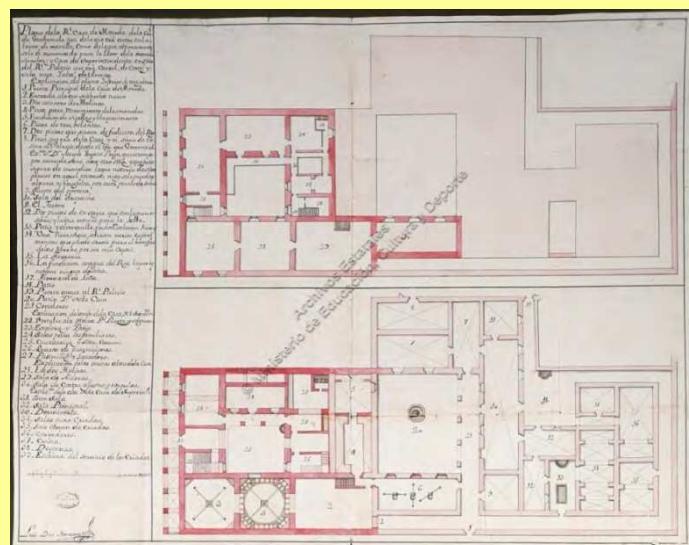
Plano de Casa de Moneda, planta alta y baja, realizado por Luis Diez Navarro. Tomado de Archivo Estatales, Ministerio de Educación y Deportes (Cortesía CNPAG).
